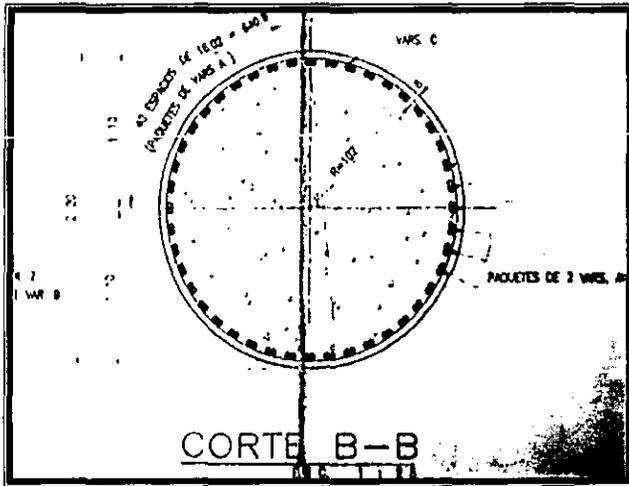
Pila circular de 2.20 m de diámetro y armado en su sección superior.
